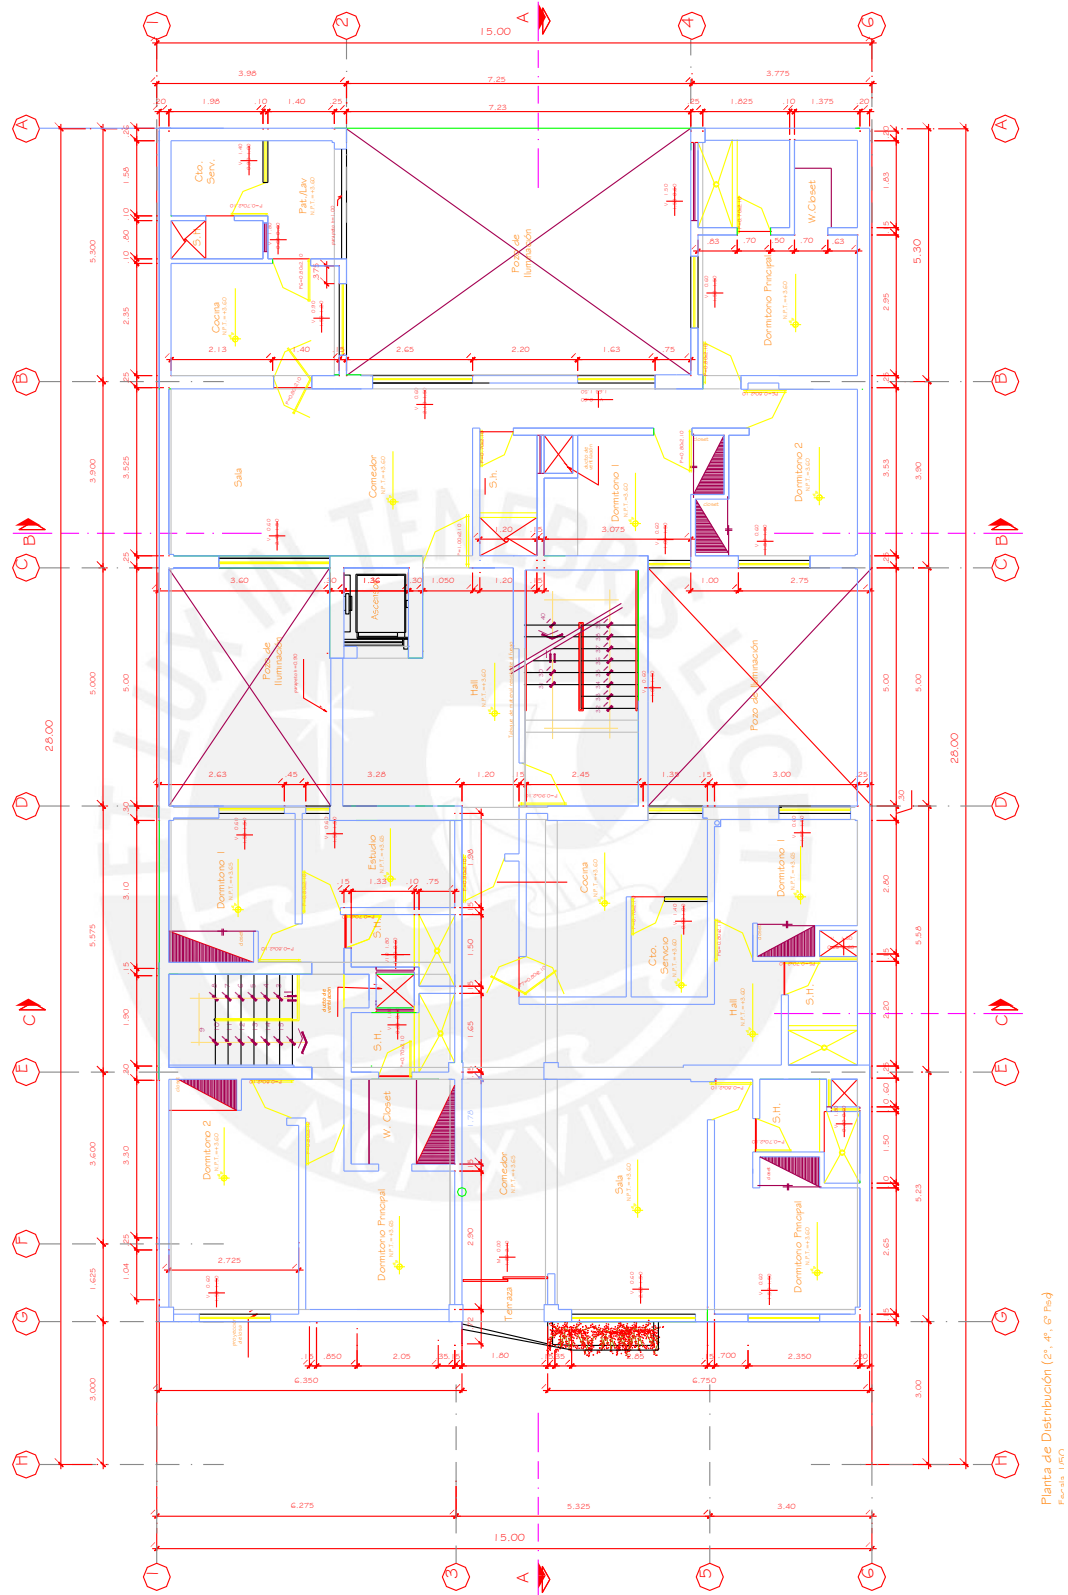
VISTA EN PLANTA DE LOS NIVELES 2,4 Y 6.
